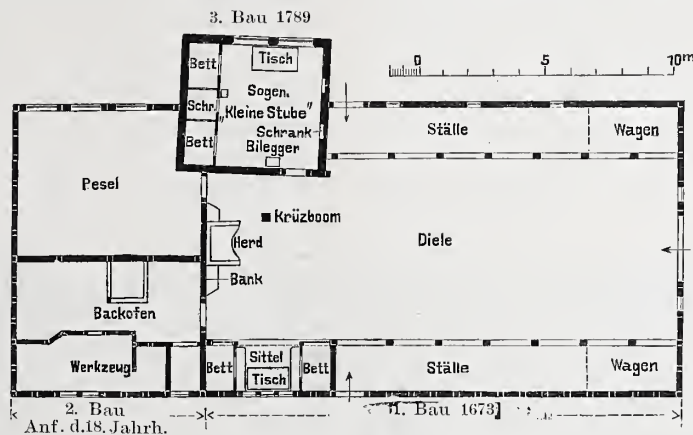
Grundriss des Heldtschen Hauses.
